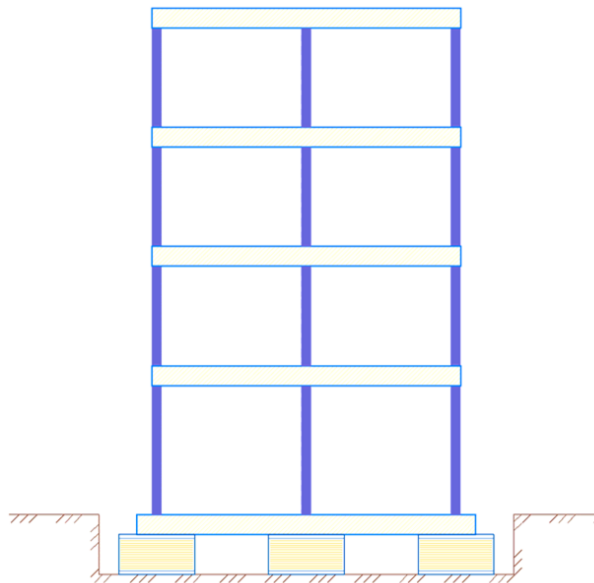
Ubicación de aisladores sísmicos en la parte inferior de las columnas de la primera planta.
